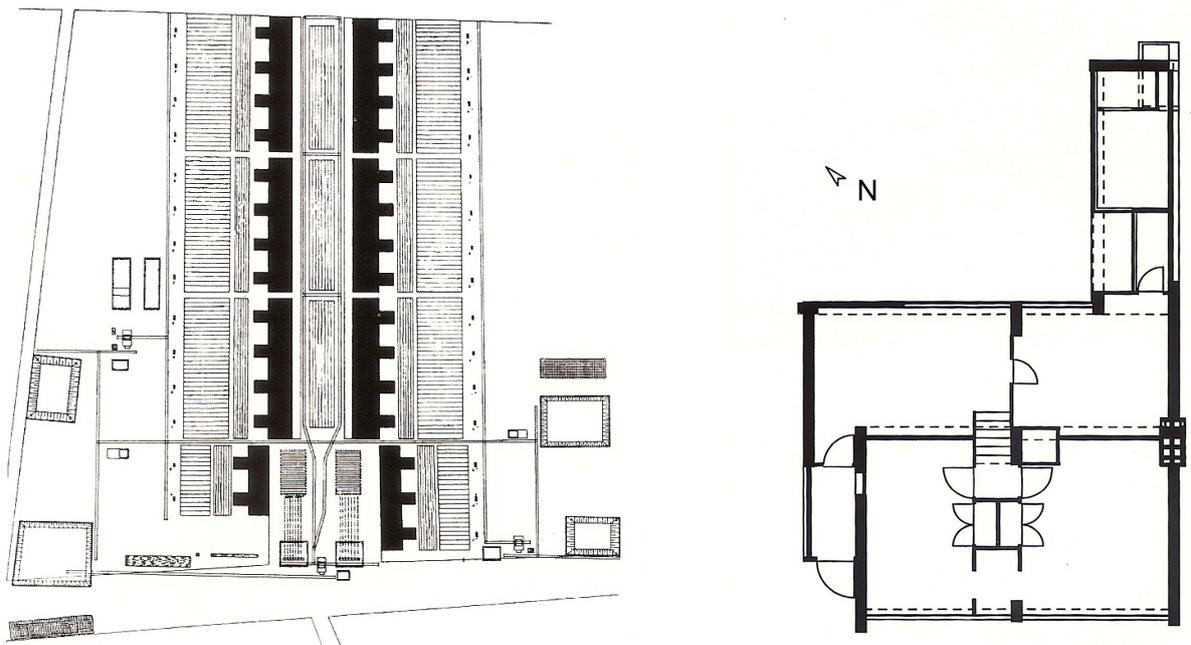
Walter Gropius - *Urbanização Törten*, Dessau, Alemanha, 1910. Planta de Implantação e Planta-Tipo de uma unidade habitacional.
